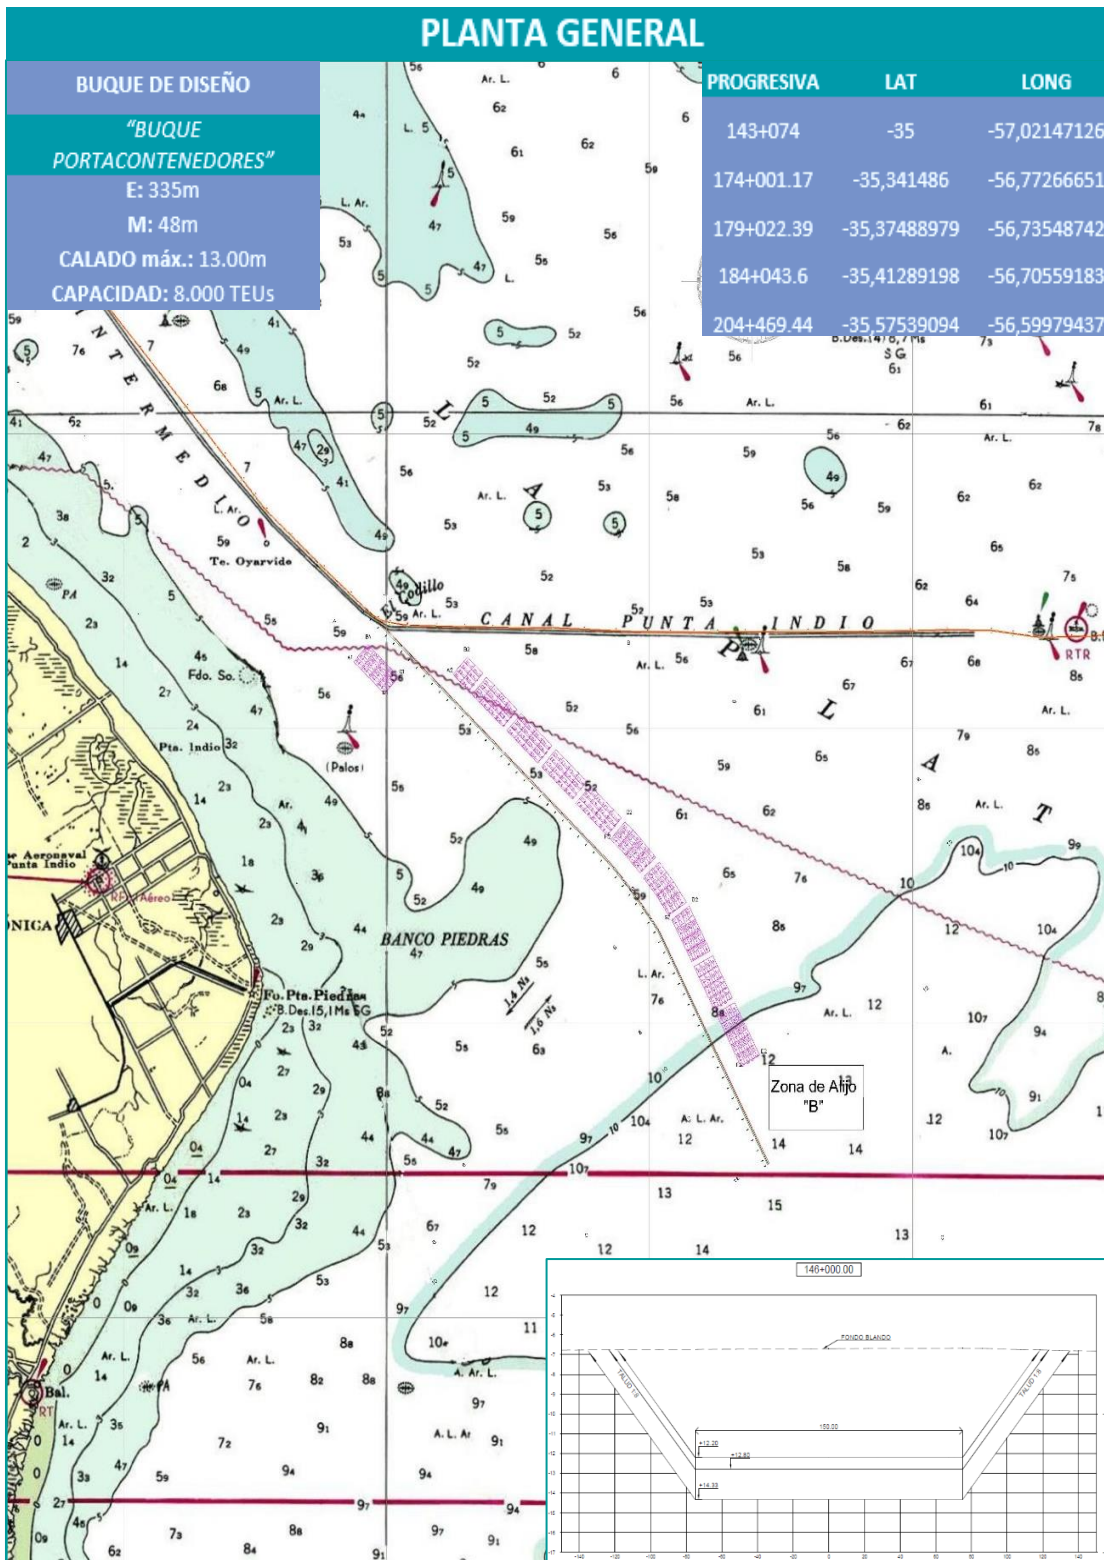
Layout original del proyecto, y parámetros de diseño. Fuente: elaboración propia.
